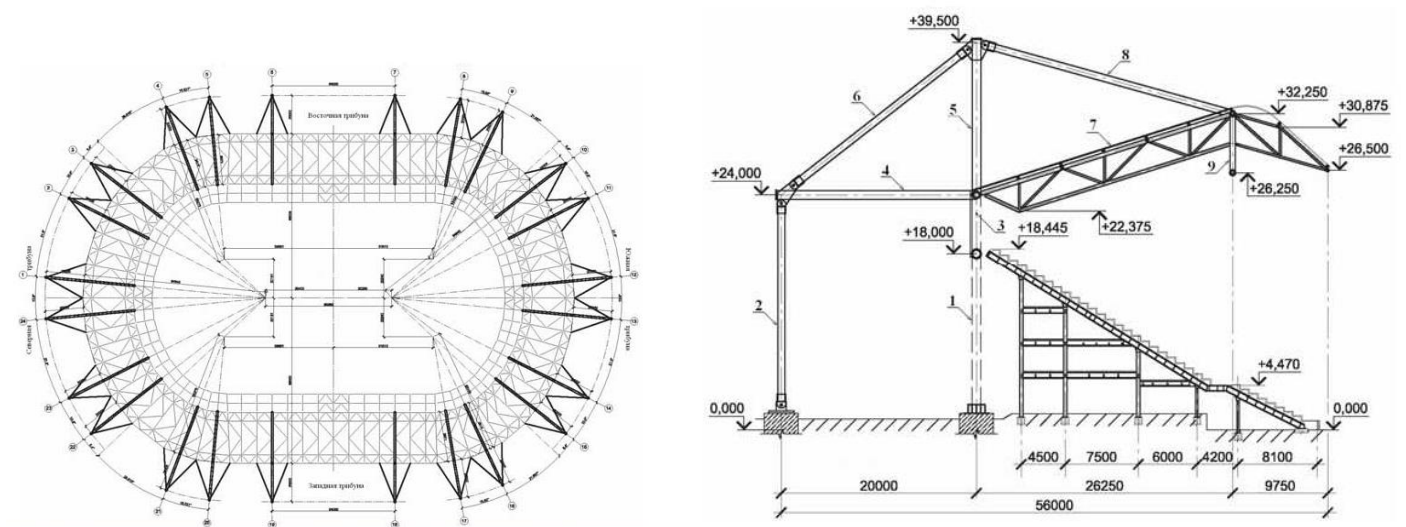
Конструкции покрытия стадиона «Металлист» в городе Харькове: 1 – V-образная опорная стойка; 2 – внешняя опорная стойка; 3 – опорно-подстропильный контур; 4 – распорка; 5 – стойка-надстройка; 6 – раскос; 7 – стропильная ферма; 8 – раскос; 9 – подстропильная ферма.
